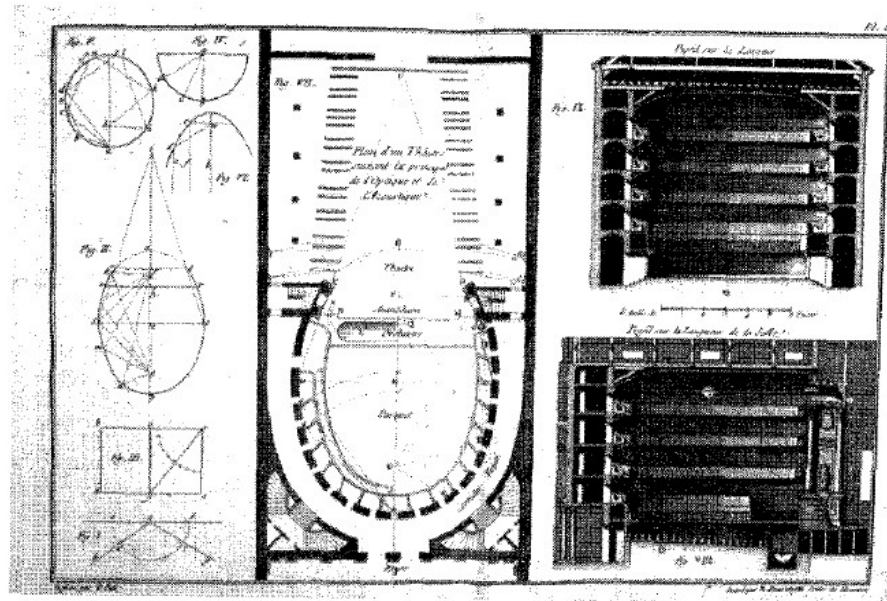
Proyecto de teatro con planta de auditorio en forma elíptica longitudinal de Pierre Patte incluida en su libro titulado “Essai sur L’Architecture theatrale” (Paris, 1782).
